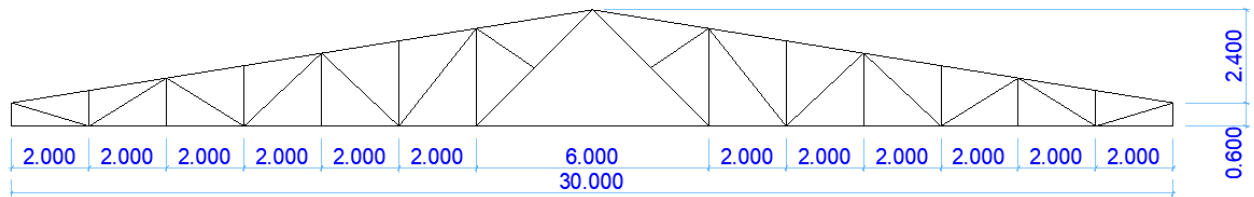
Vista de la geometría propuesta como armadura principal
